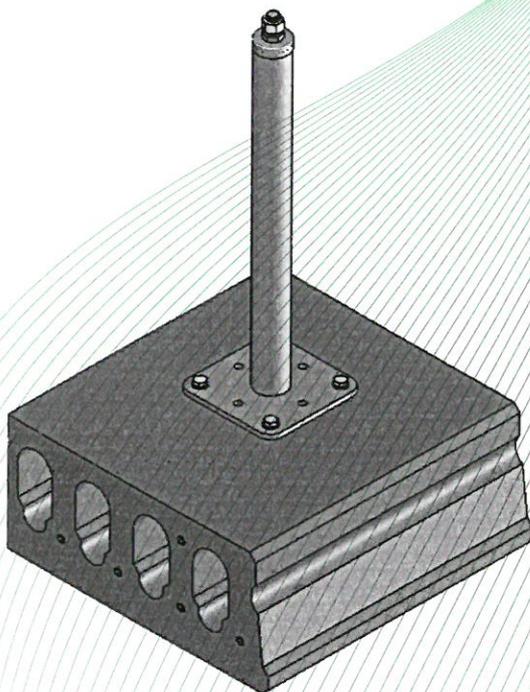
Anschlageinrichtung, Typ: SAFEX VARIANT montiert auf einer Stahlbetonhohldiele
